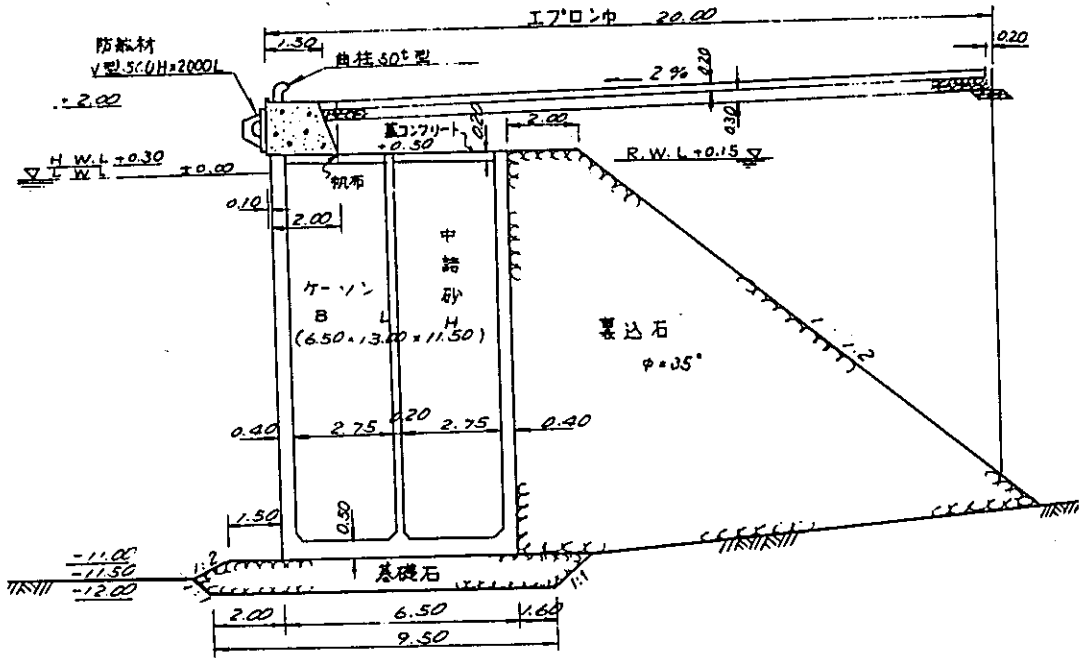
墨湖港 10,000 DWT 級岸壁標準断面図 (S=1/100)
